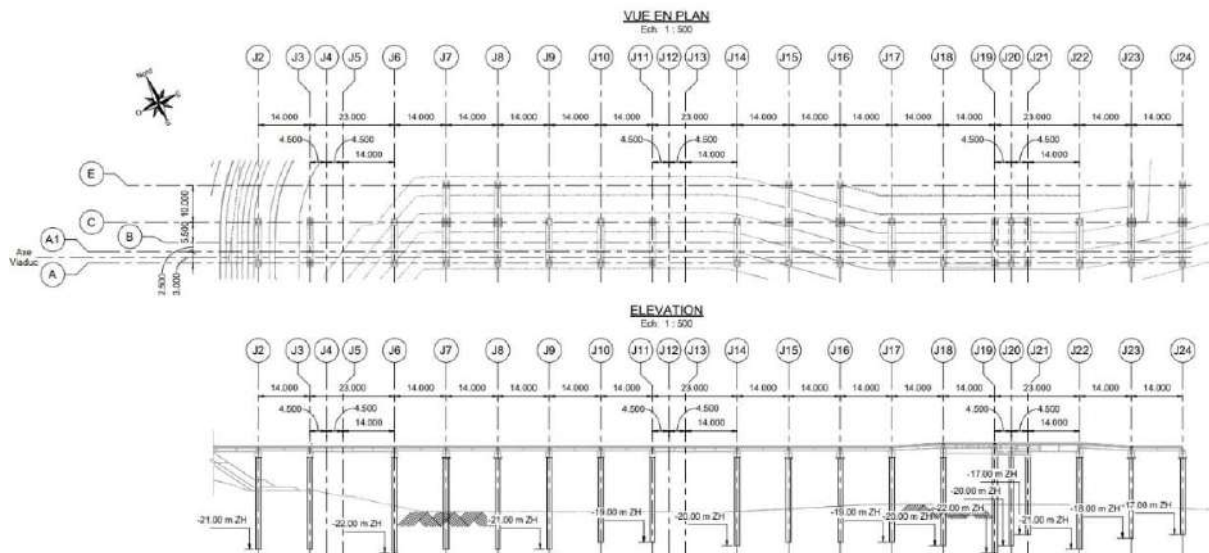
Plan d'implantation des pieux de la jetée P1 PLN
